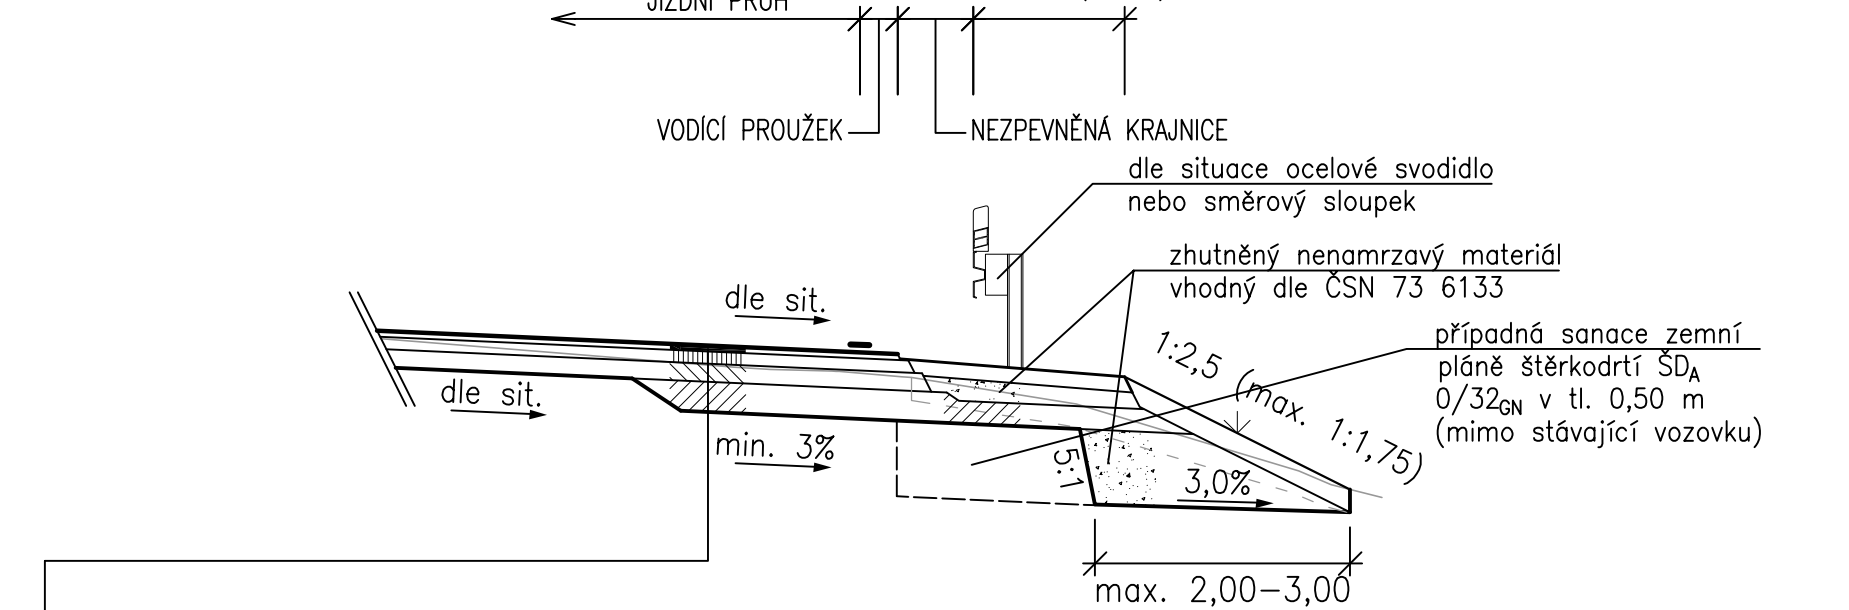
DETAIL – OTEVŘENÝ ŽLAB Z KOSTEK
